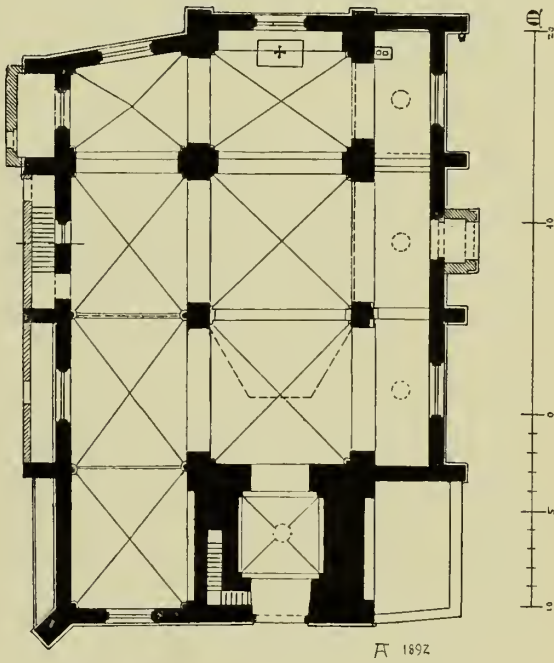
Essen. Grundriss der Marktkirche.
